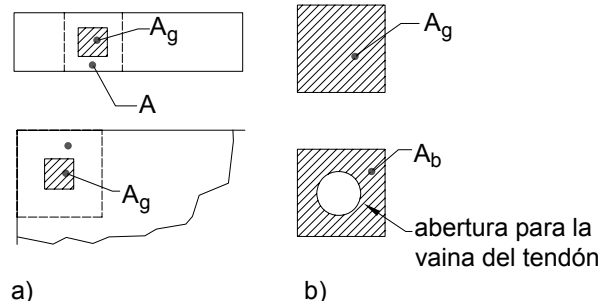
Área de la superficie de apoyo de hormigón para la Ecuación 2
